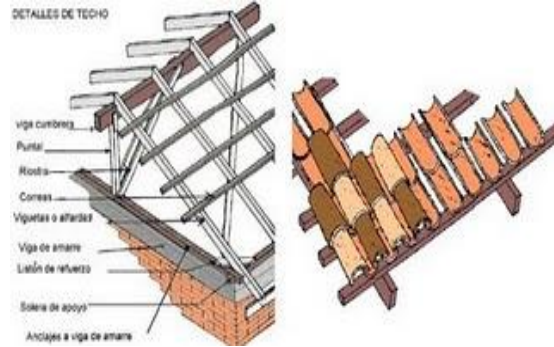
Topología de cubiertas. Fuente: <http://artistasdlaconstruccionv.blogspot.com>
